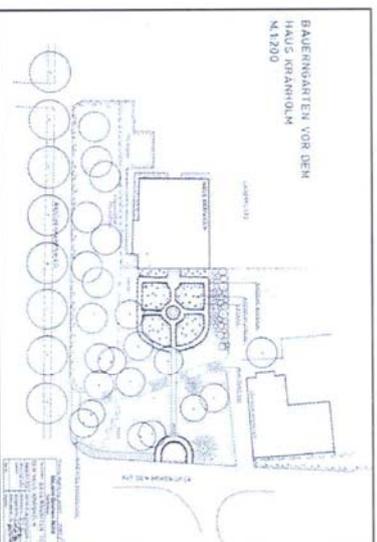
Haus Kränholm mit Schmuckanlage und Obergärtnerhaus – hier auf einem Plan von 1982 – ist als wichtiges prägendes Ensemble zu erhalten.
